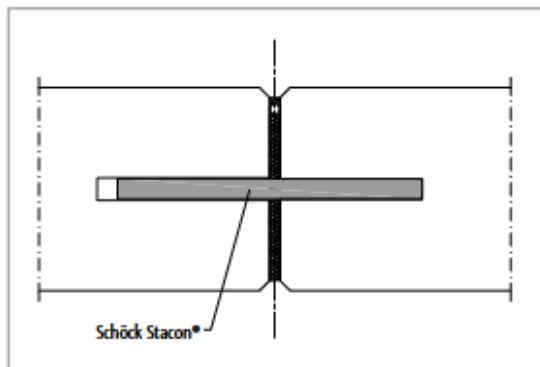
Schöck Stacon®: Dehnfugenausbildung Ort beton
